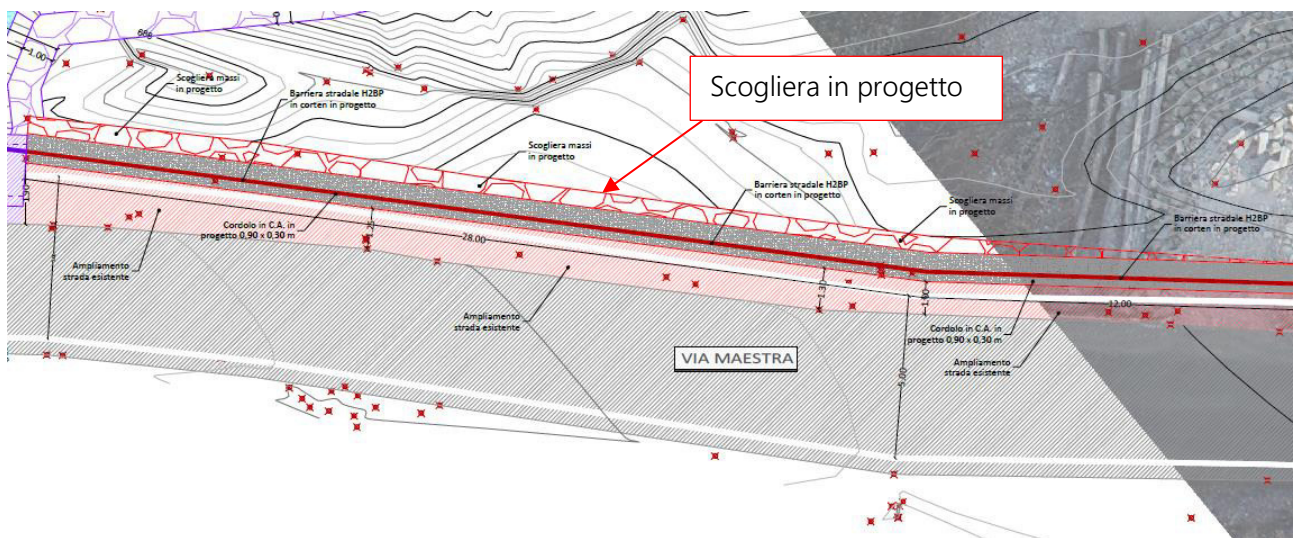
Tav. 02_ Planimetria di progetto – Sezione di verifica
